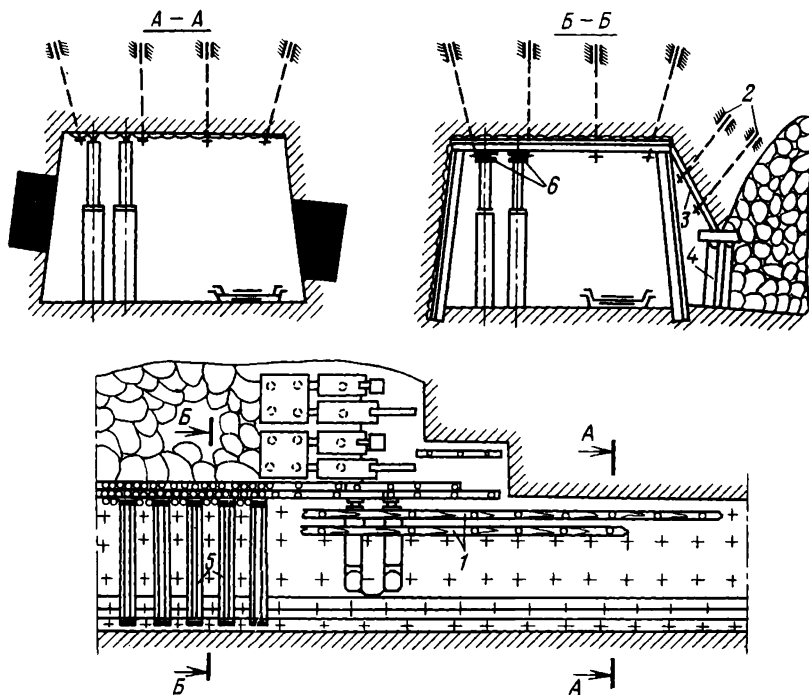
Схема крепления сопряжений лав со штреками, сохраняемыми для повторного использования при обработке пластов со слабоустойчивыми кровлями
